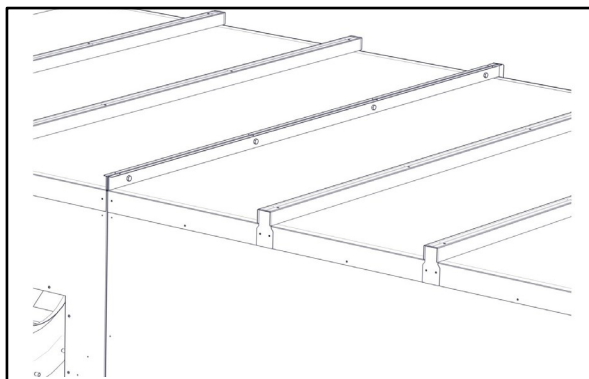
EMPLACEMENTS DES BOULONS DE L'ASSEMBLAGE DES POUTRES DE TOIT
